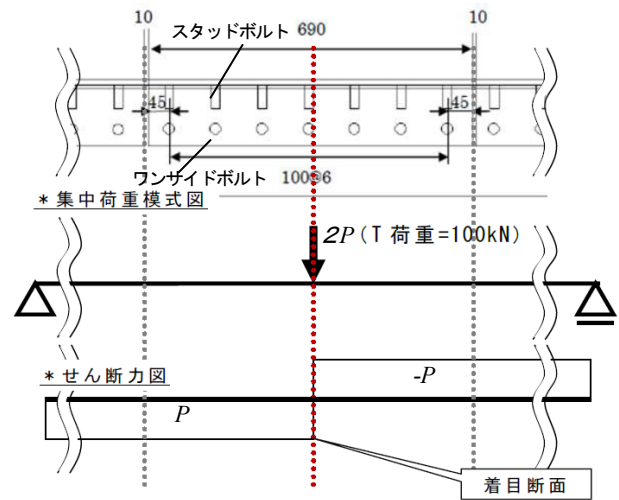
橋軸直角方向断面およびせん断力図 (単位: mm)
